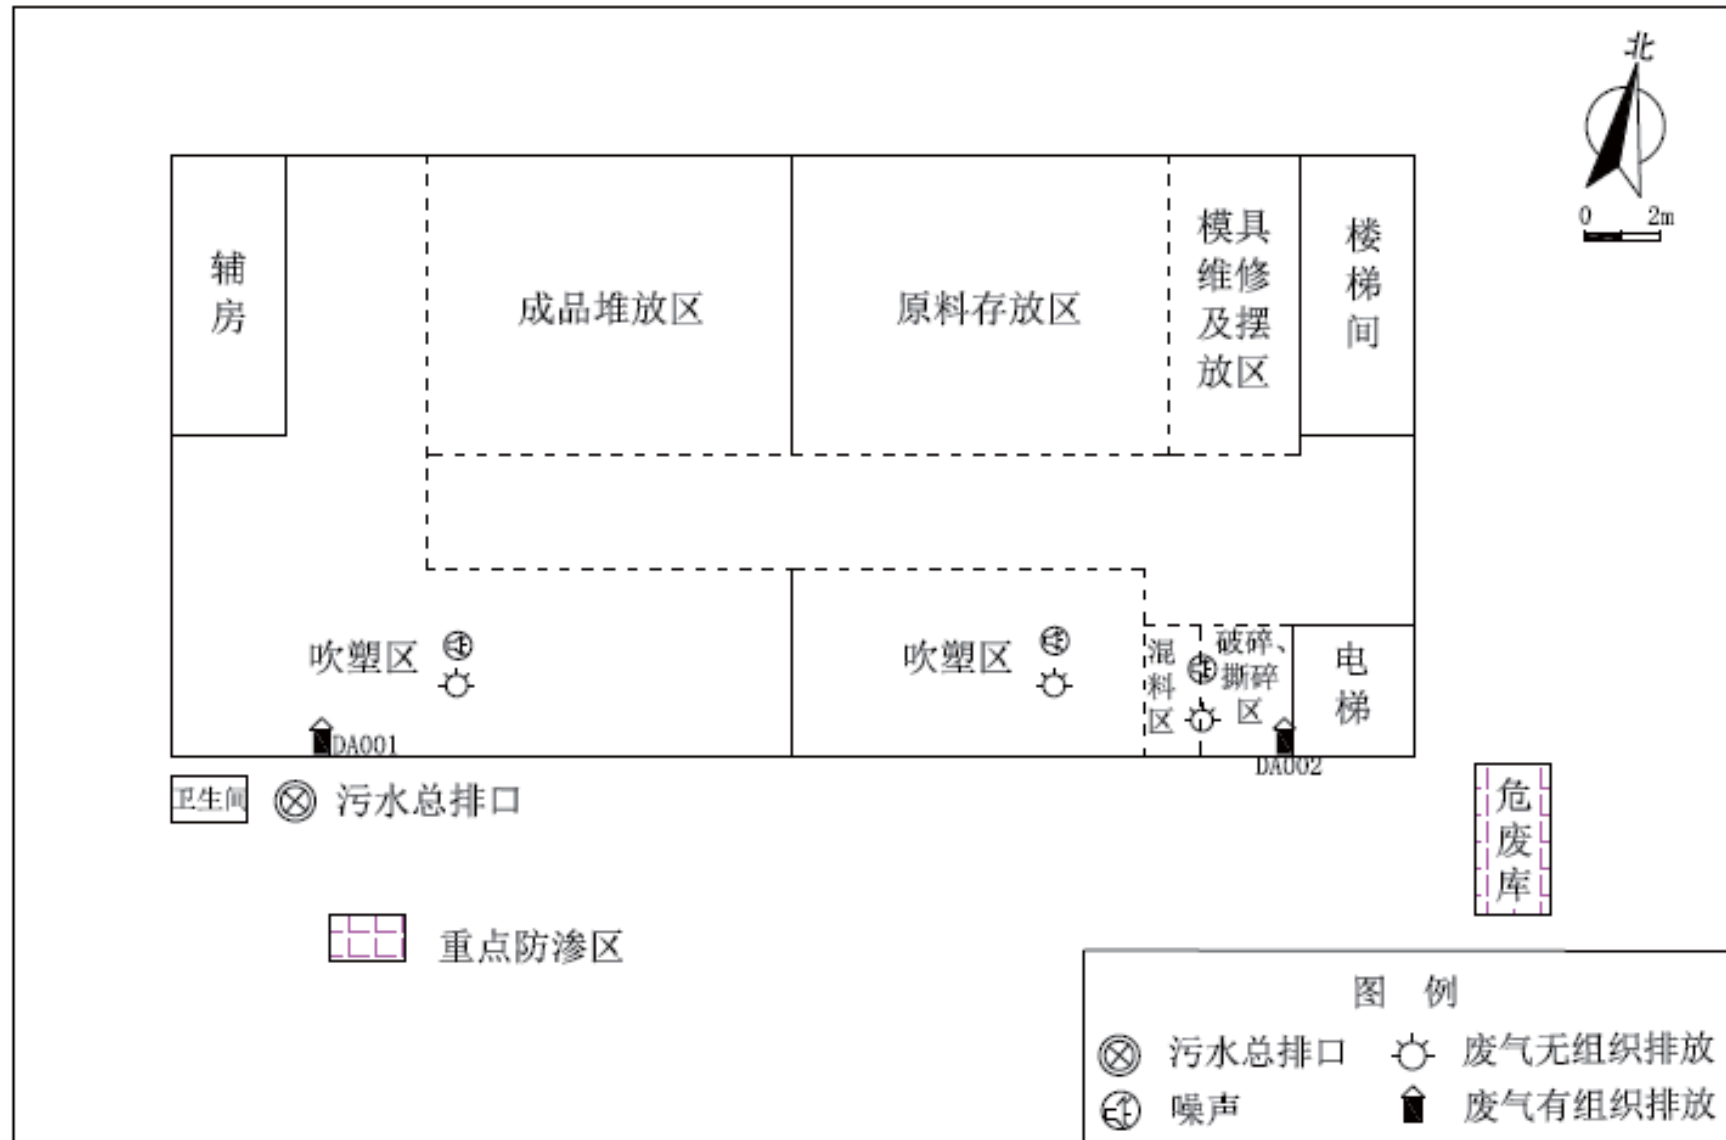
建设项目生产车间一层平面布置图（实际建成图）
